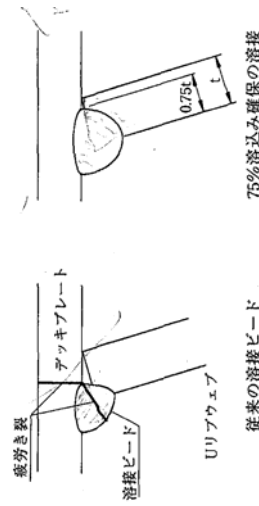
閉断面リブとデッキプレートの溶接
